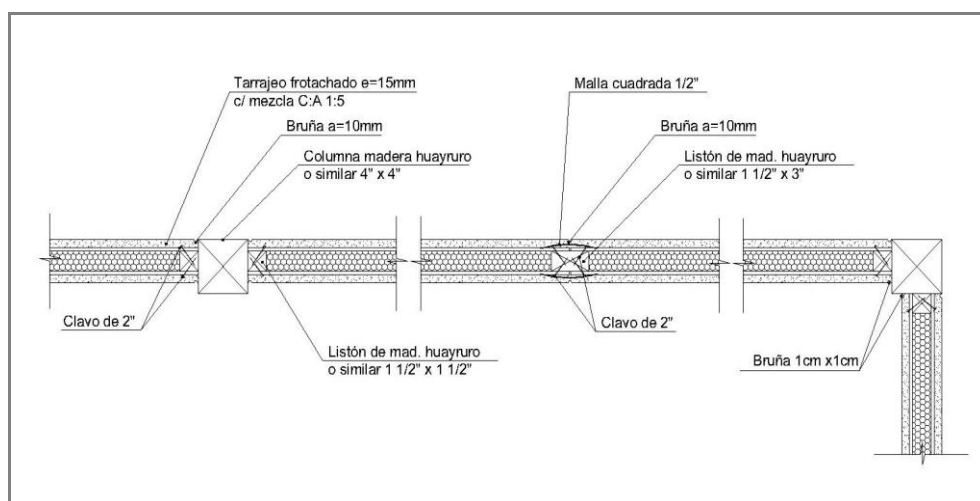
Detalle constructivo de tabique TECNOBLOCK y estructura de madera
